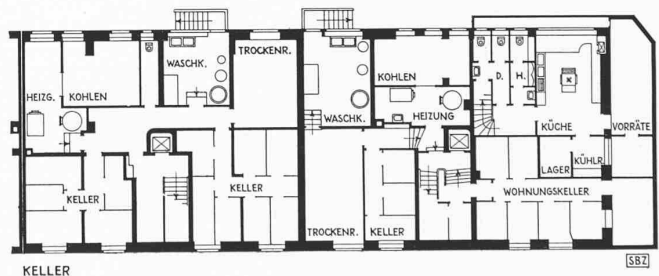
und 2. Oben Erdgeschoss-, rechts Keller-Grundriss 1:400
